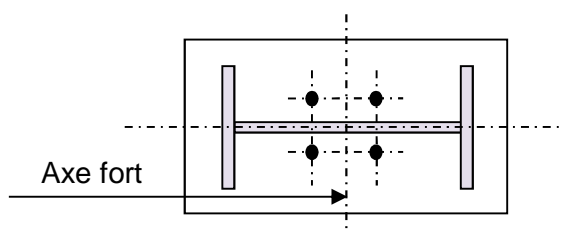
Pied de poteau articulé comportant quatre tiges d'ancrage.
